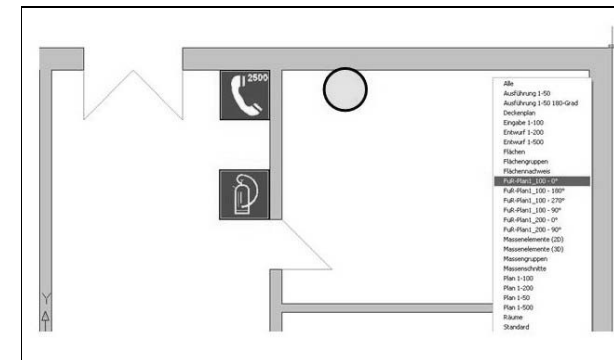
Grundriss in der Standardausrichtung
